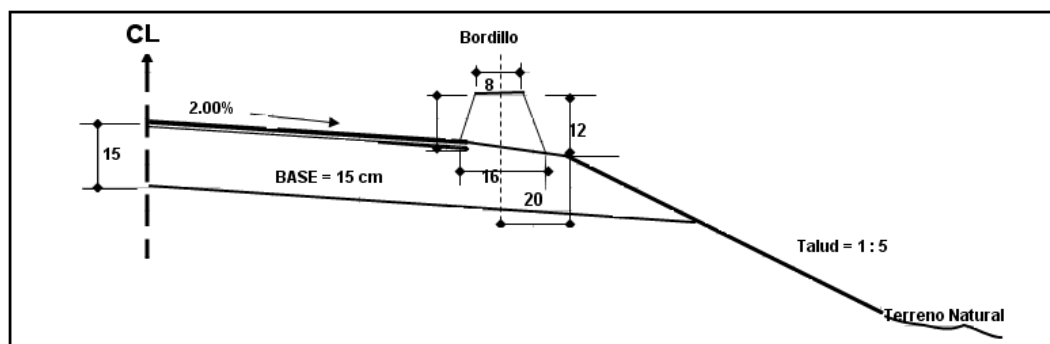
Perfil de un Bordillo que se construirá en la obra
